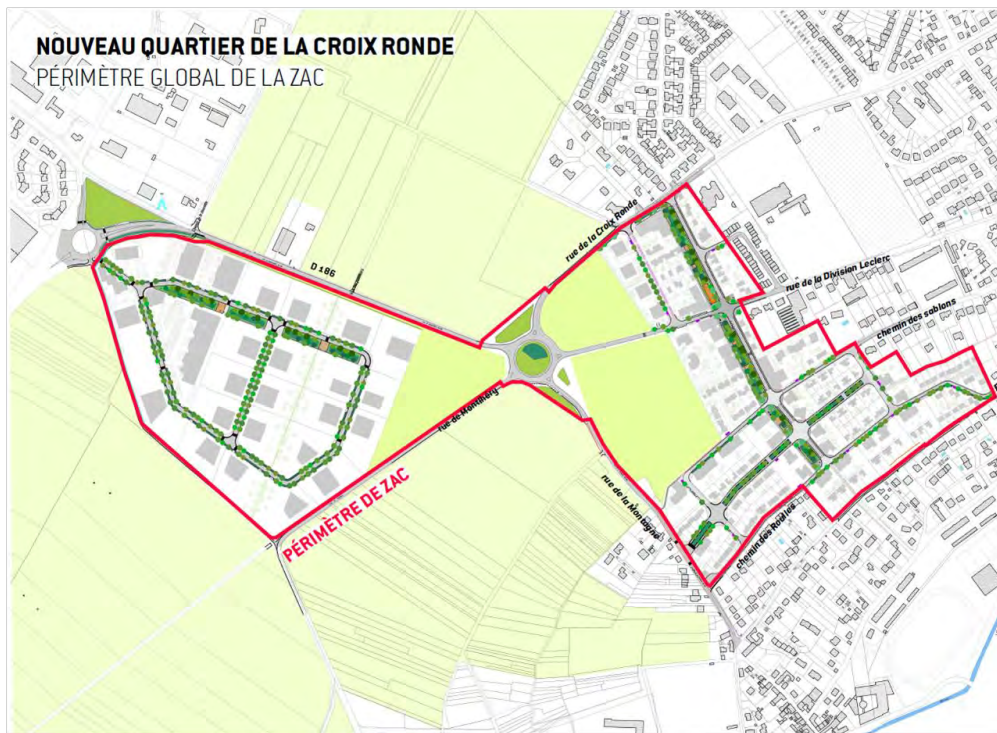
Plan d'aménagement du quartier de la Croix Ronde
